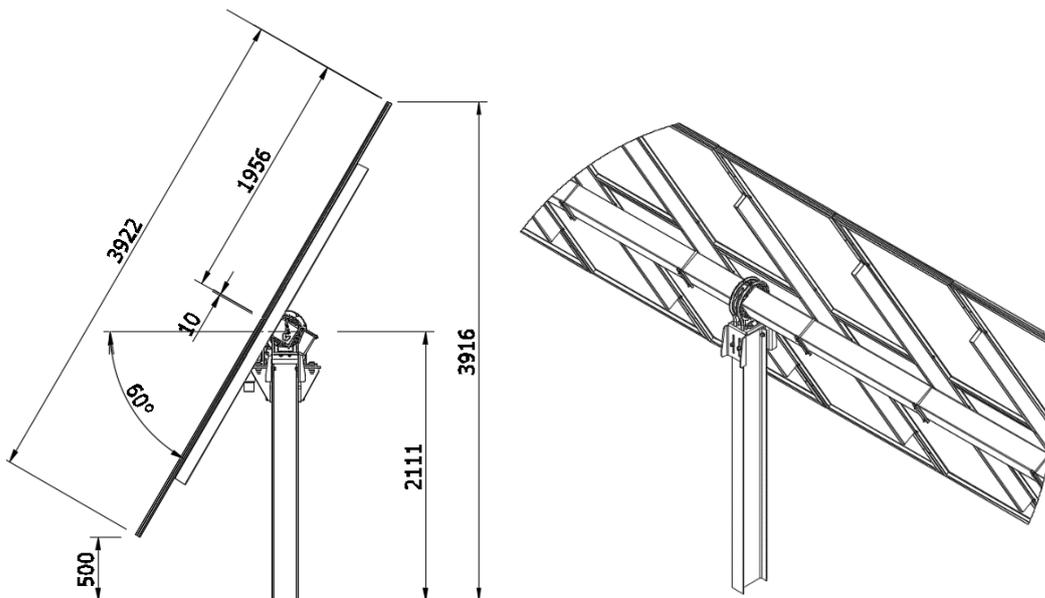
Perfiles de Seguidor Soltec y detalle eje.
